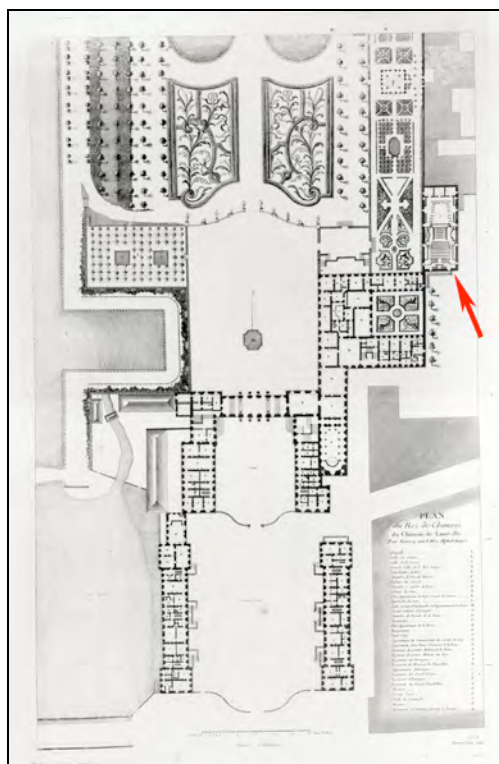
Localisation du théâtre construit en 1733 - Héré E., *Recueil des plans, élévations...*, Paris : François, 1752, détail du plan du rez-de-chaussée ©Région Lorraine - Inventaire Général
